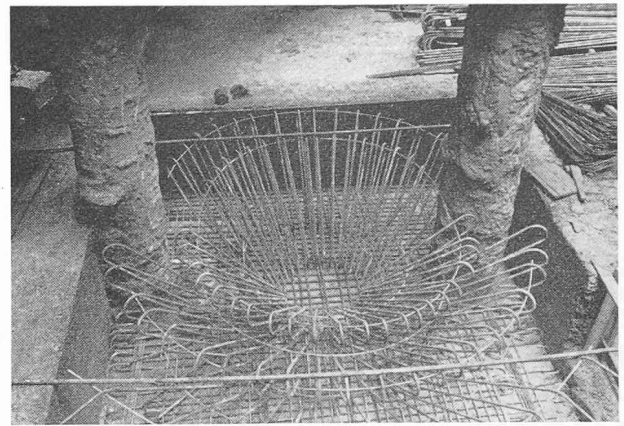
Fondations : armatures en dessous de l'appui d'un poteau.
